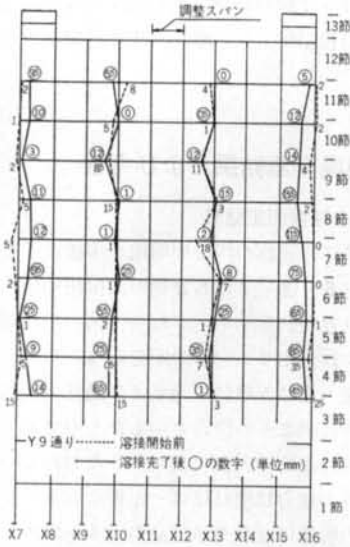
B建物の溶接前・後の柱の位置の例 (立面図)
